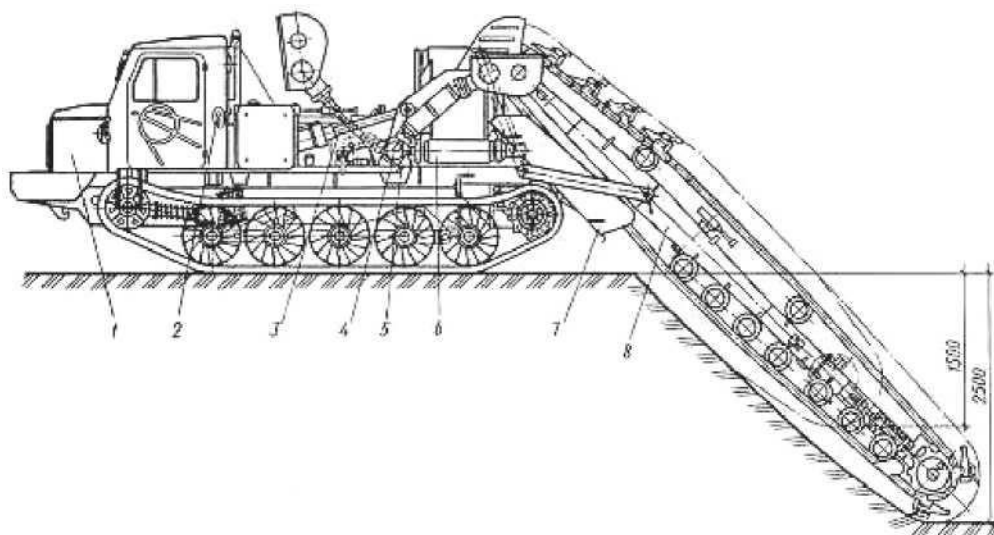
Траншейный цепной экскаватор: 1 - двигатель; 2 - кабина; 3 - гидропривод; 4 - трансмиссия; 5 - механизм подъема и опускания рабочего органа; 6 - конвейер; 7 - облицовка экскаватора; 8 - рабочий орган
